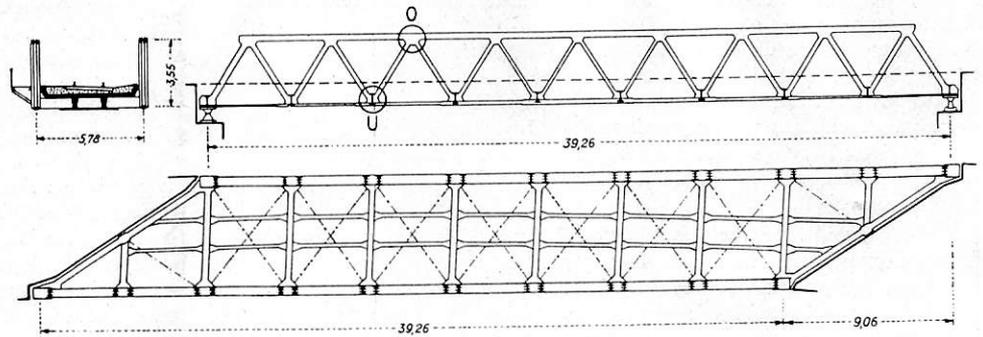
Grundriß, Ansicht und Schnitt der geschweißten Eisenbahnbrücke Joncherolles. Maßstab 1:400.
